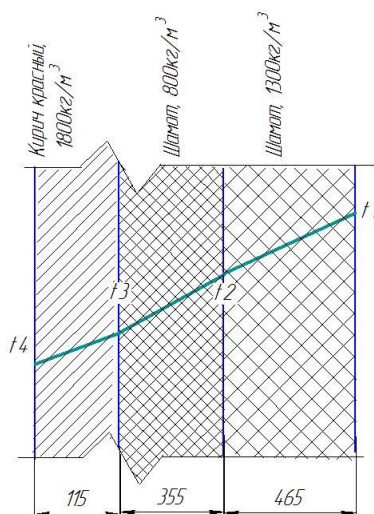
Разрез футеровки стены на 42 – 46 позициях
